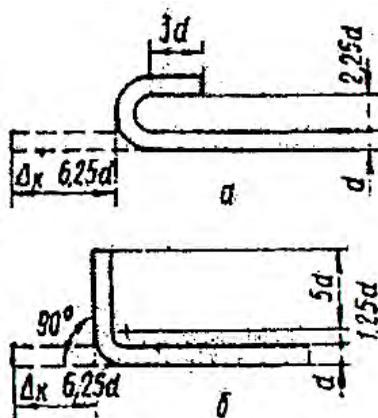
Размеры крюка (а) и лапки (б) на концах круглых гладких стержней рабочей арматуры
